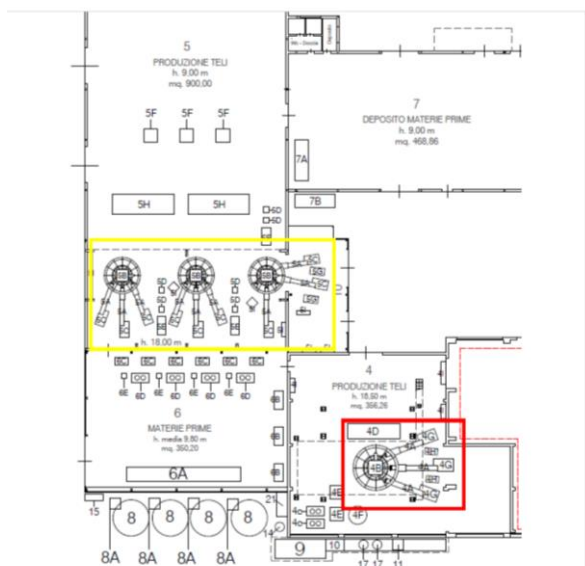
Stralcio della tavola "Planimetria dei locali di lavorazione", allegato n.7.
